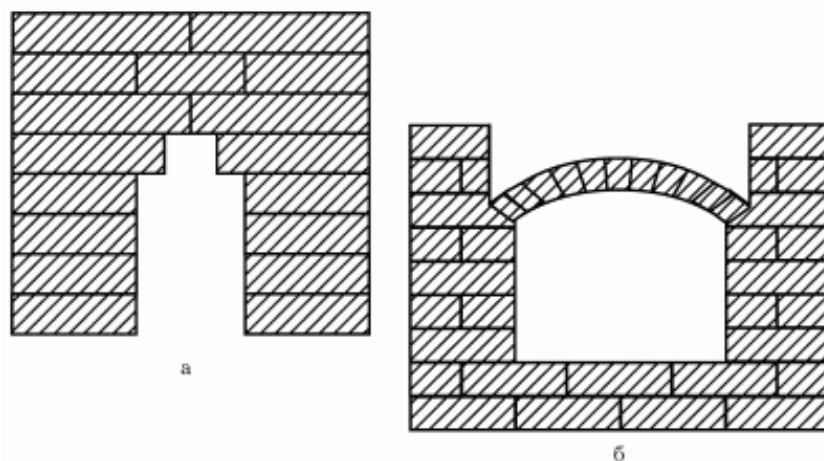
Печные перекрытия: а – на выпусках; б – арочное (свод).
